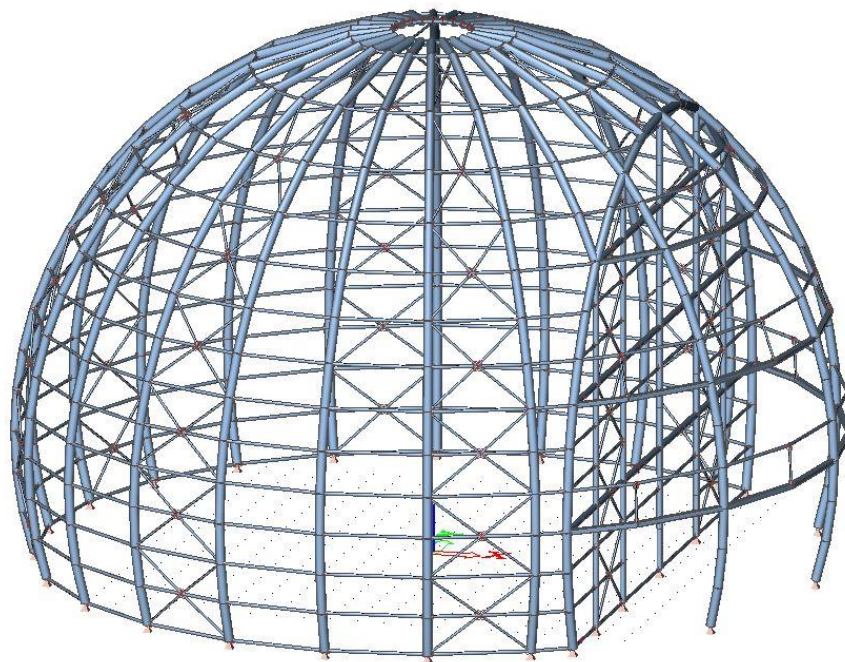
Vnitřní ocelová konstrukce – varianta 1
